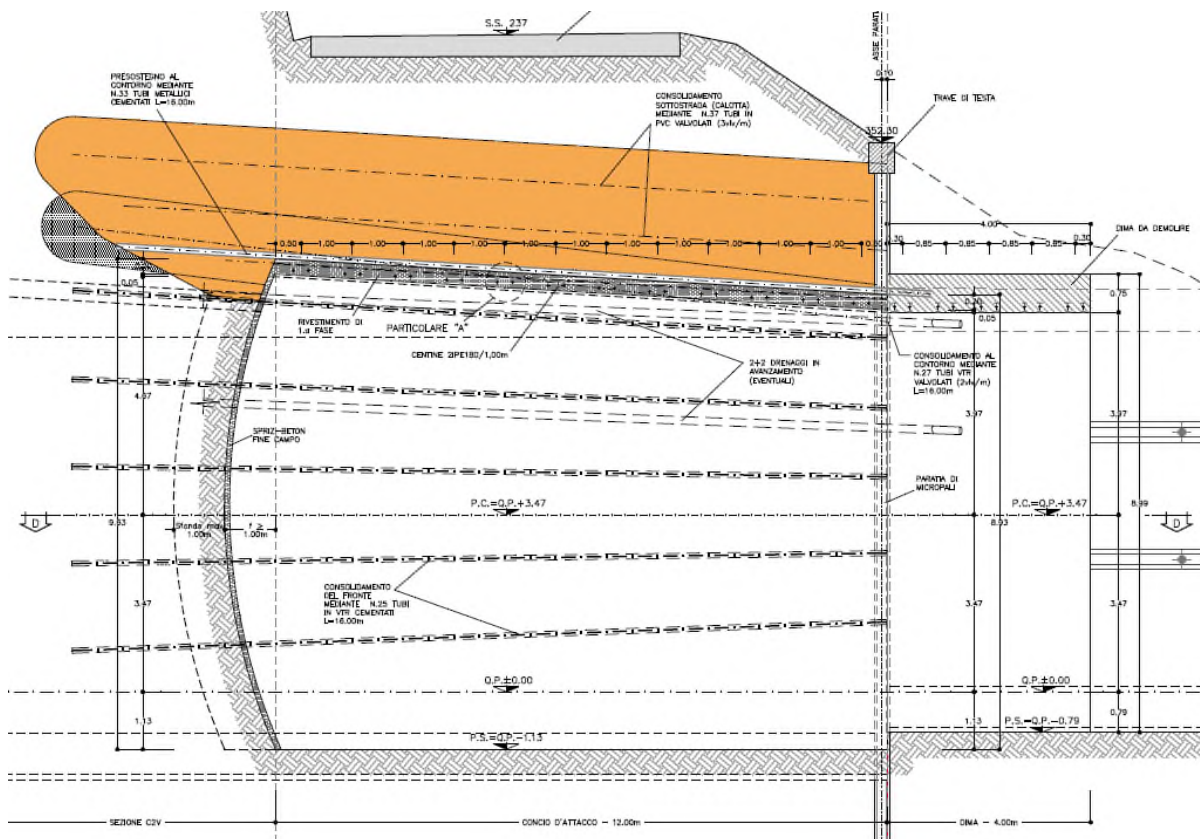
Sezione di Attacco – Scavi e consolidamenti – Profilo longitudinale
